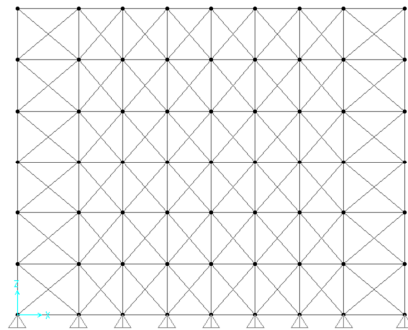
Configuração dos Planos de Contraventamento Vertical Com Elementos de Contraventamento Pequenos
